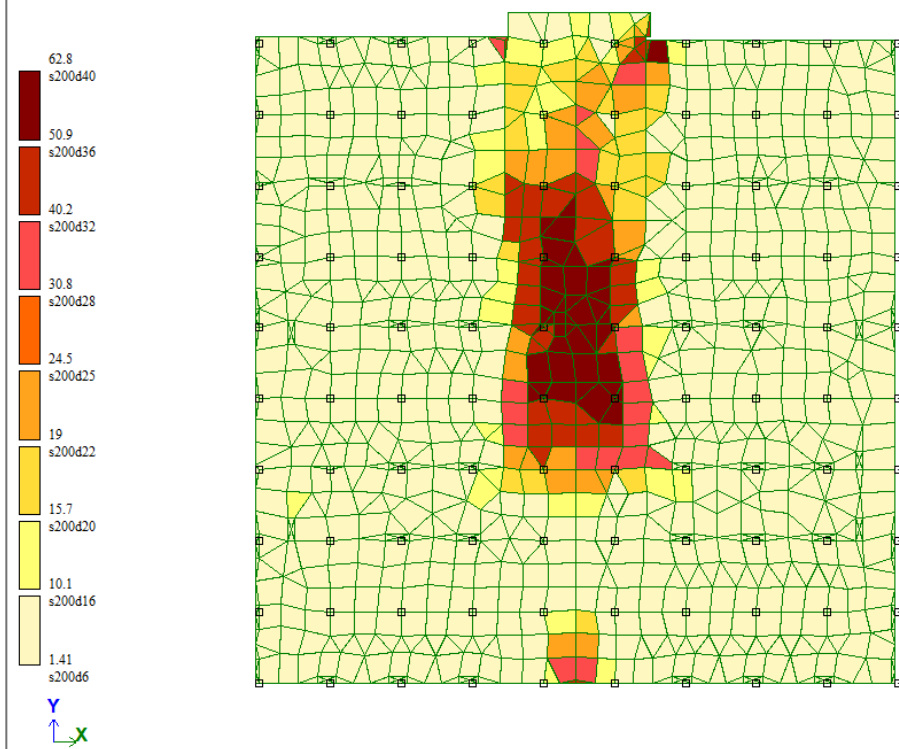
Схема армирования низа фундаментной плиты по оси OX
